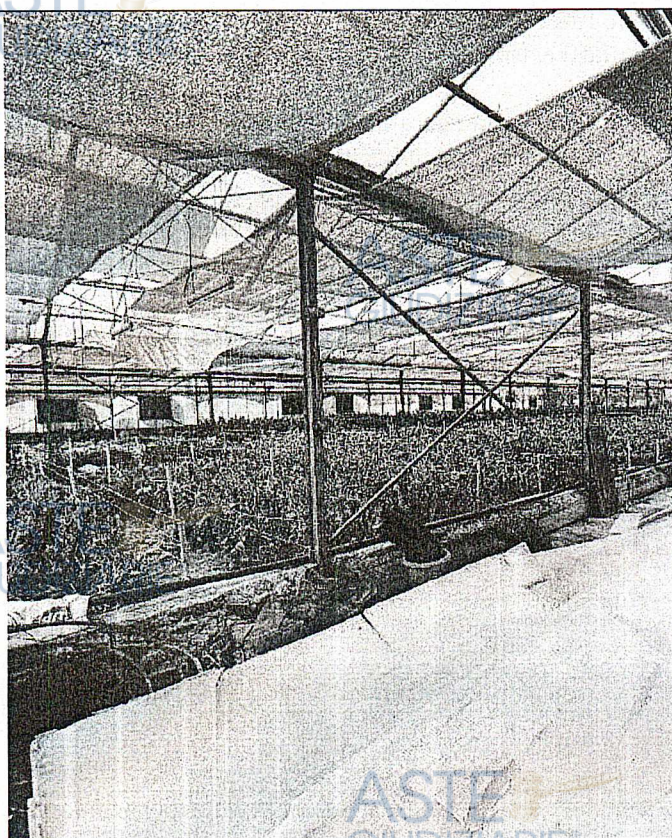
Vista dell'interno della serra n.1. Si rileva che mancano alcune lastre del tetto in plexiglas
